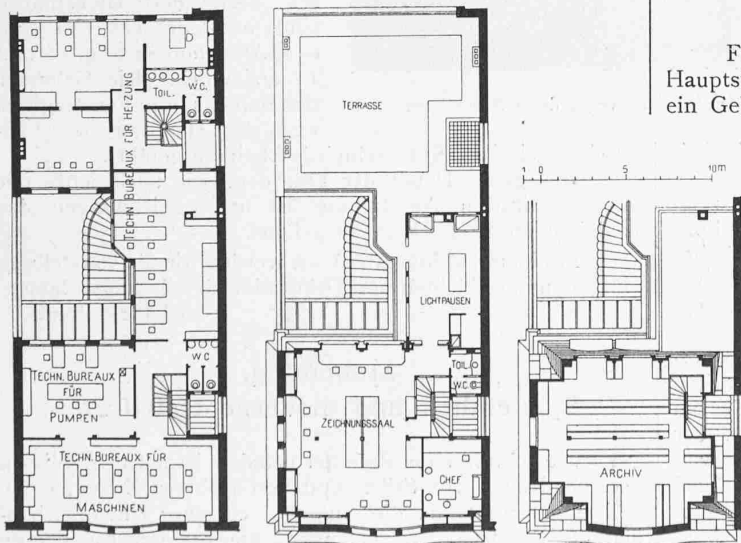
bis 7. Grundrisse vom II. und III. Obergeschoss und vom Dachgeschoss des Vordergebäudes an der Avenue de la République. — Masstab 1 : 400.
